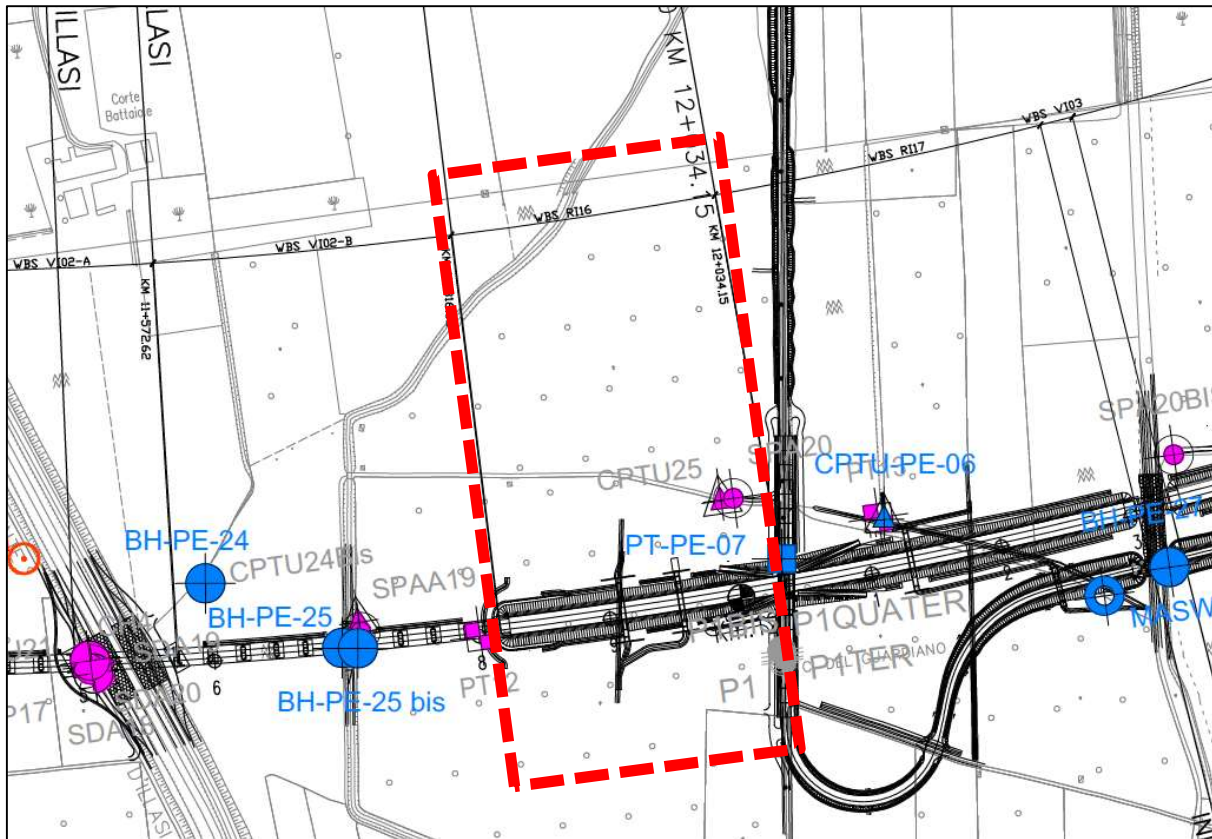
Planimetria Rilevato R16, estratto dalla Planimetria Generale (Doc. Rif.[3])
